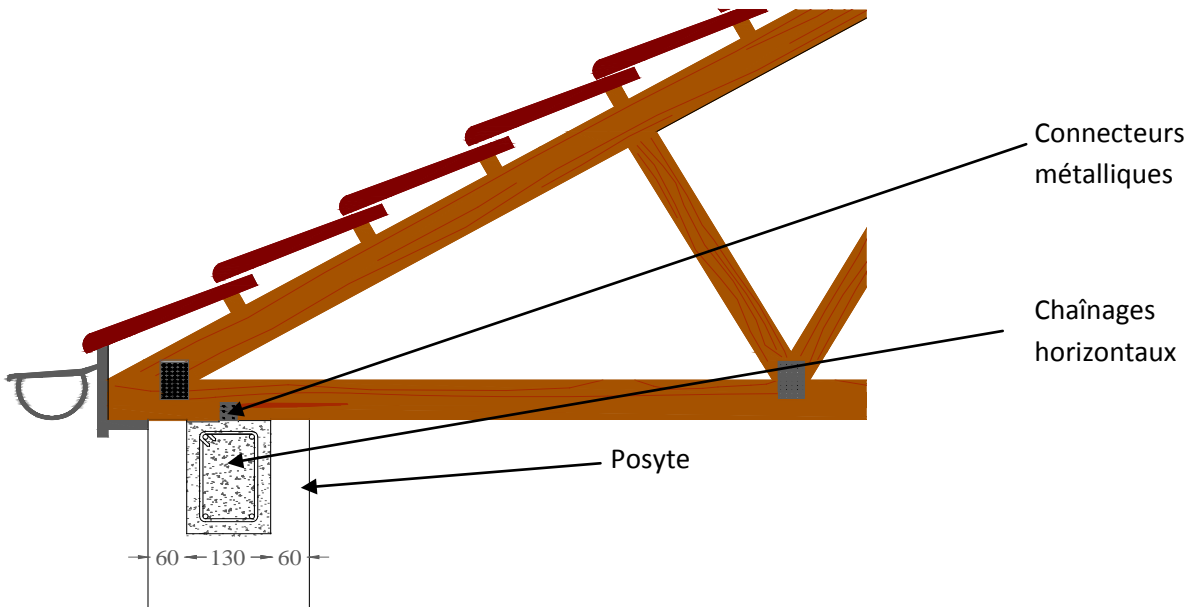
Détail d'une coupe au niveau de la toiture avec le châînage horizontal
